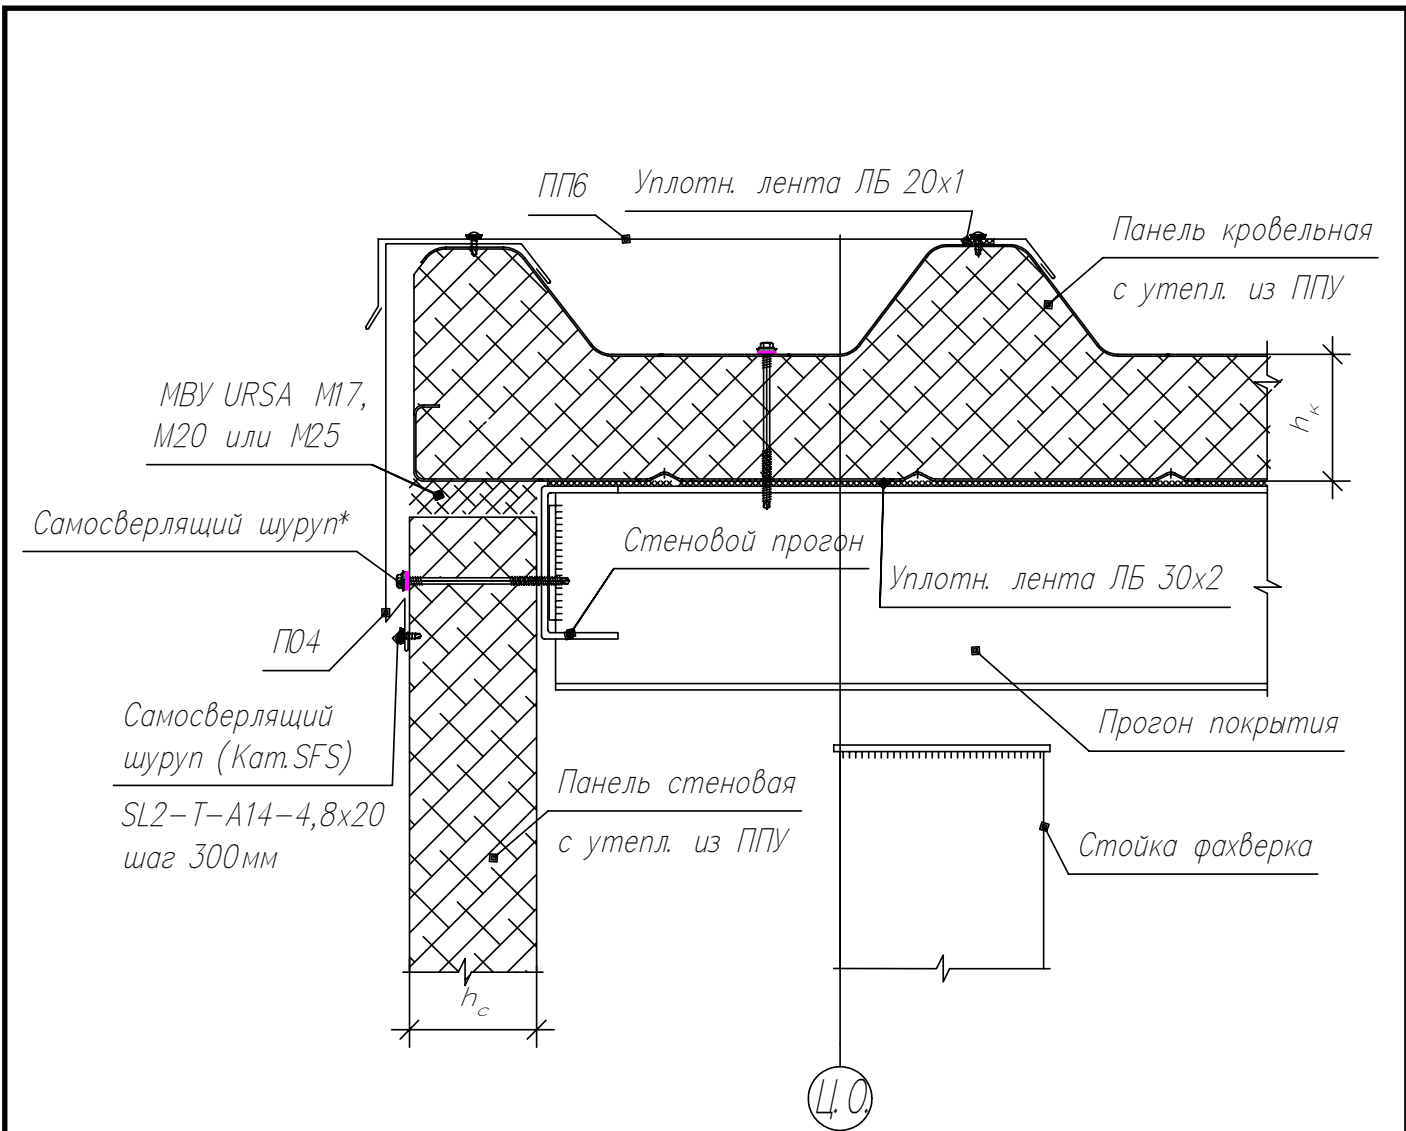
а – Карнизное сопряжение стеновых и кровельных панелей
